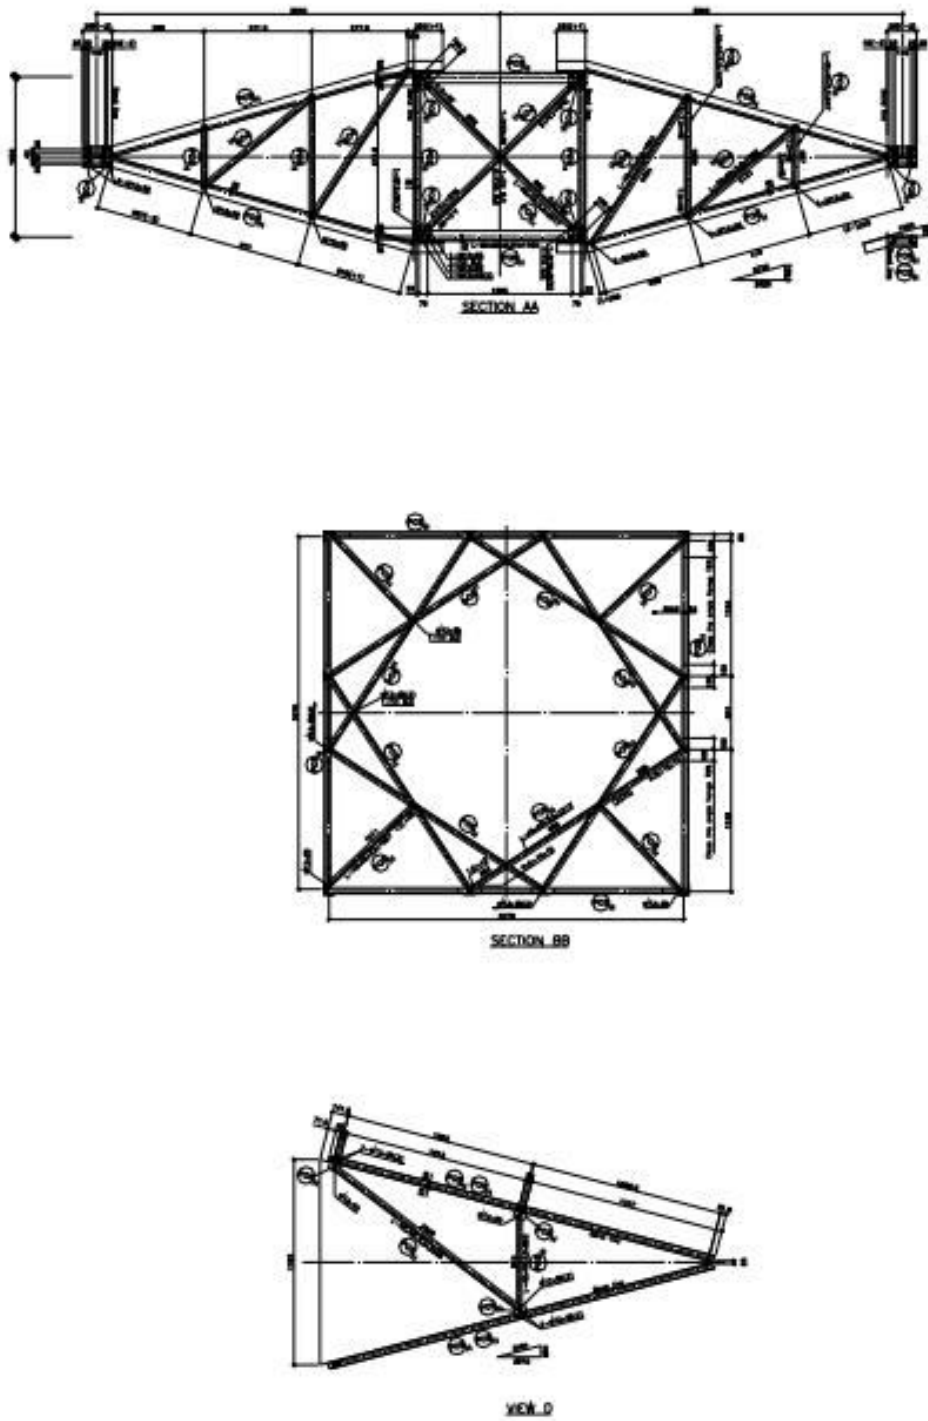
Estrutura “2”- detalhamento dos corte AA, BB e vista D.
